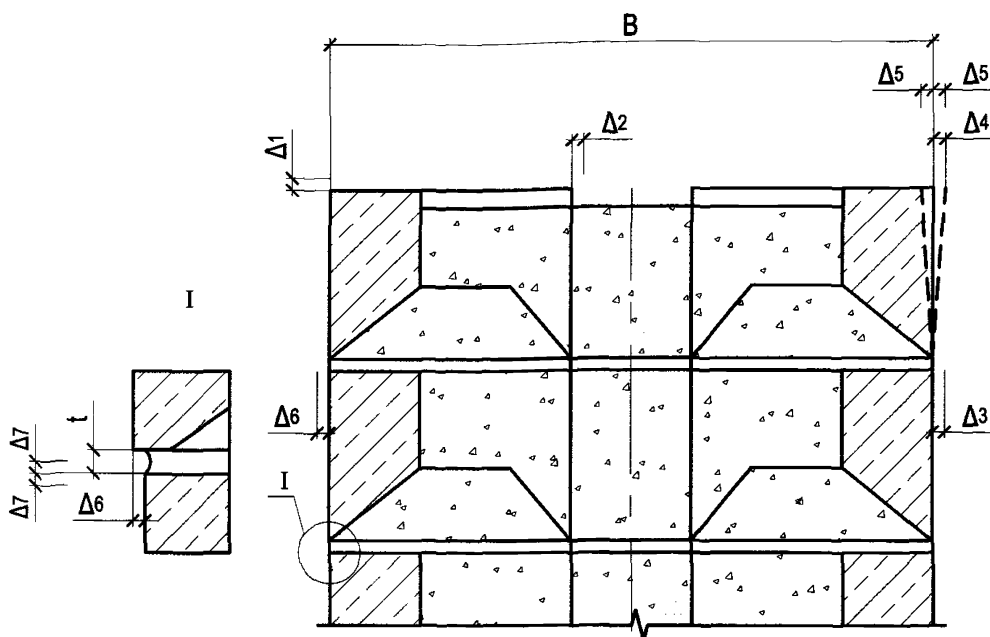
Схема опоры с массивной облицовкой из железобетонных контурных блоков с указанием предельных отклонений
